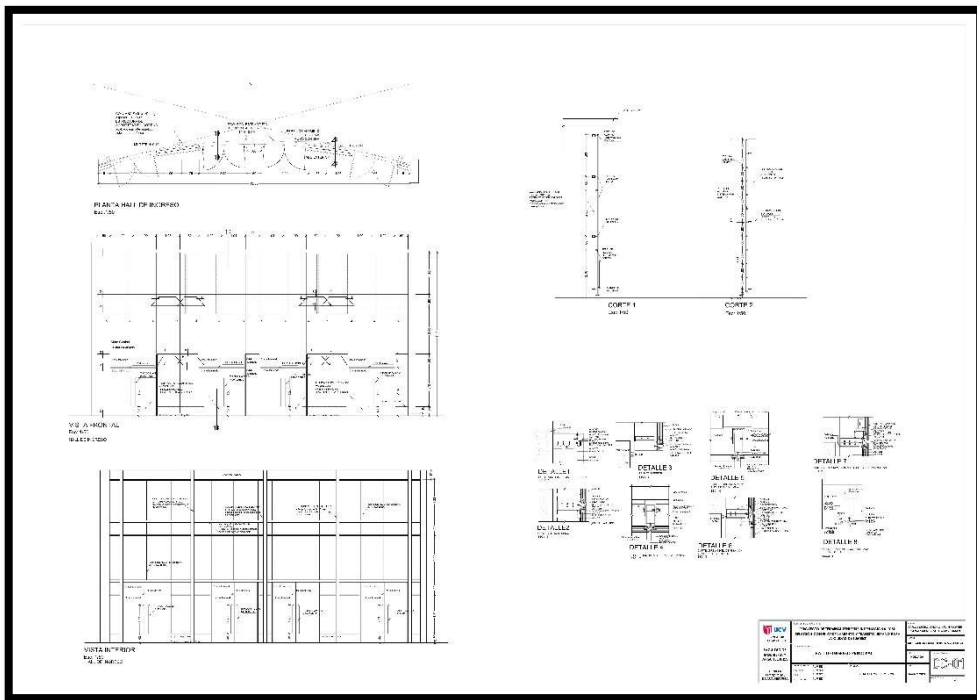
Plano de Detalles Constructivos. Fuente: Elaboración Propia.
